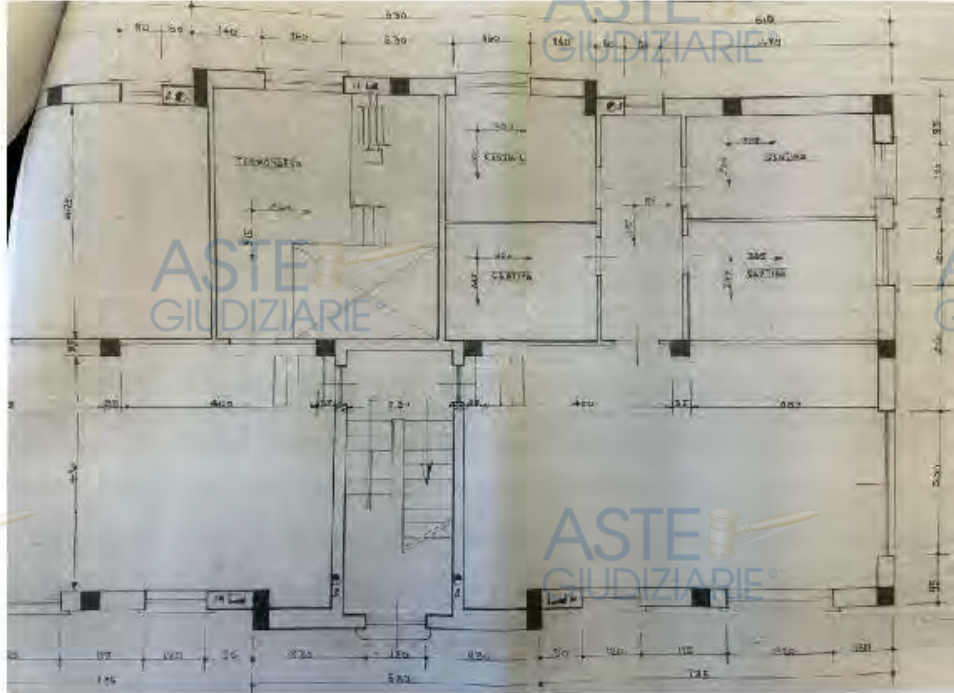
Estratto Licenza costruzione n. 3 dell'08/02/1966 piano terra
